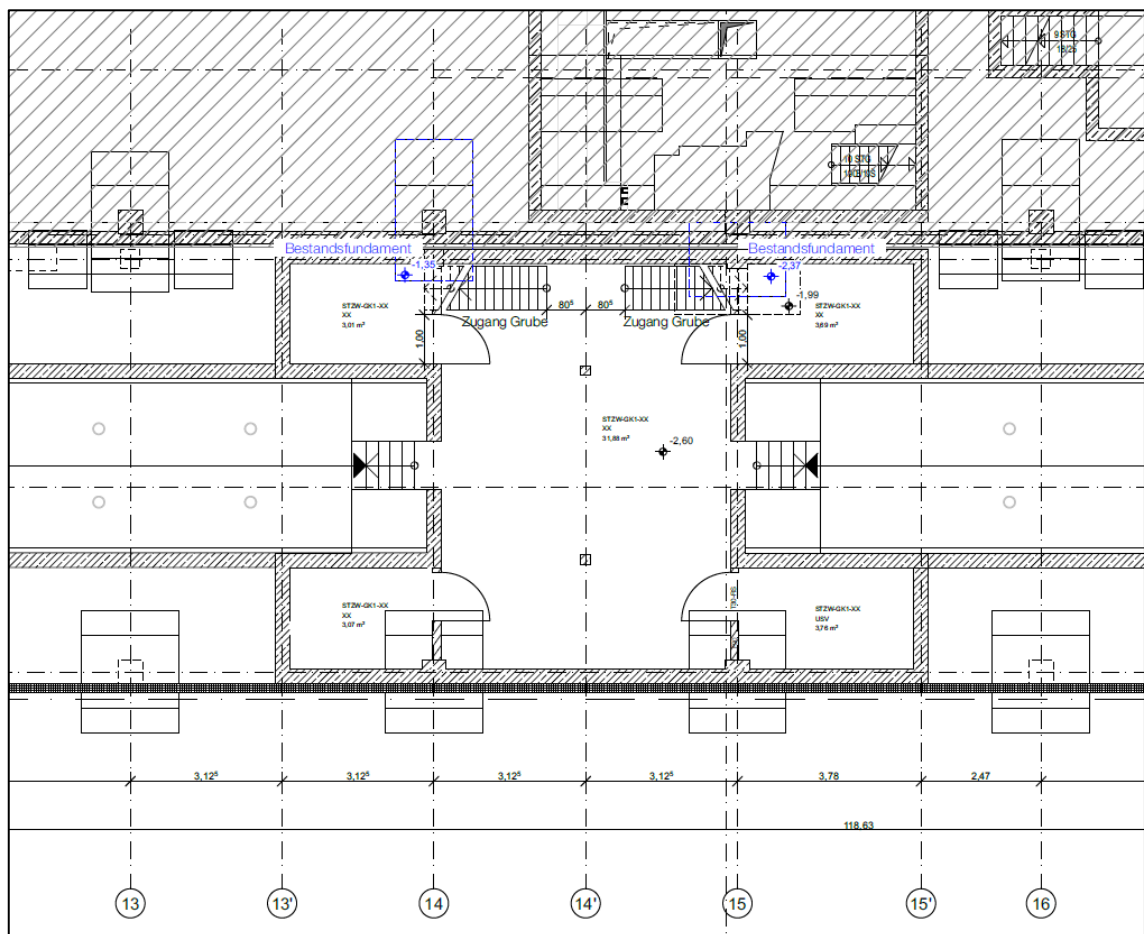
Grundriss Untergeschoss [2.a]
